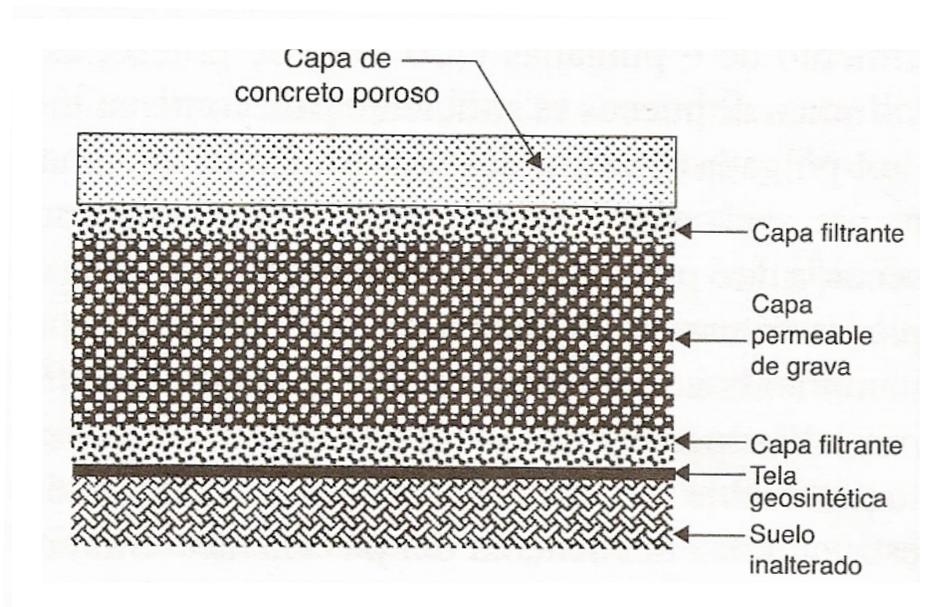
Estructura de un pavimento de concreto permeable (ACI 522, 2006).
